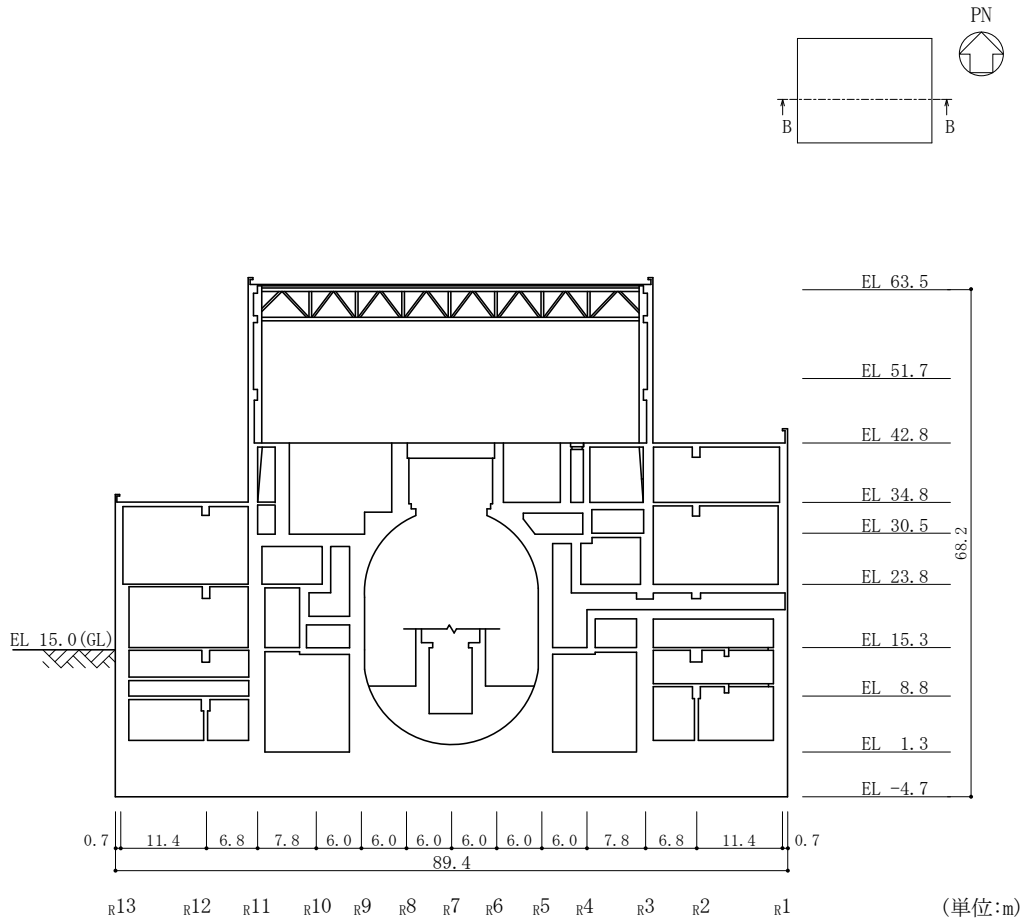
(2) 原子炉建物の概略断面図 (B-B断面, EW方向)
